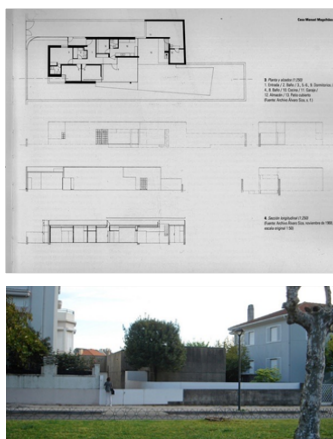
Casa Manuel Magalhães Planta y alzados (Planos) y vista exterior de la fachada principal Oporto de 1967-70. Alvaro Siza.
